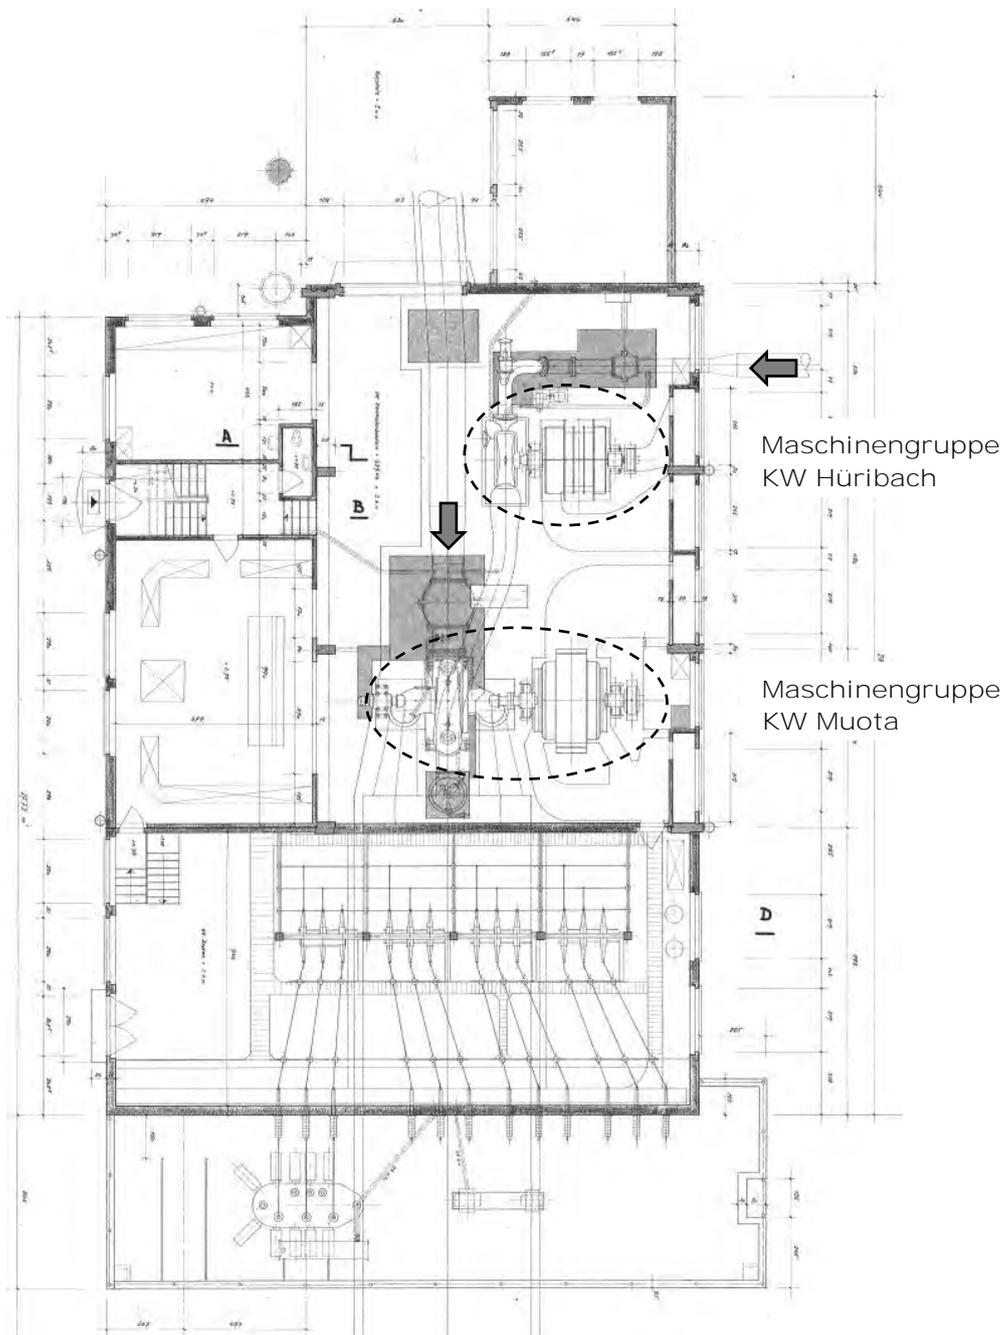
Grundriss des bestehenden Maschinenhaus Hinterthal (Erdgeschoss, Ausschnitt Plan Nr. 500-103).
